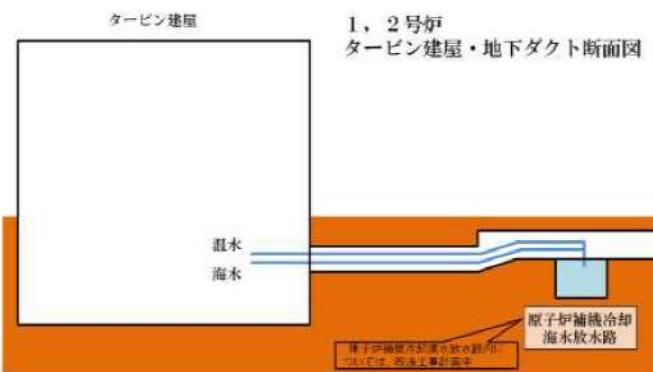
温水ピット及び海水ピット排水ライン 断面図
